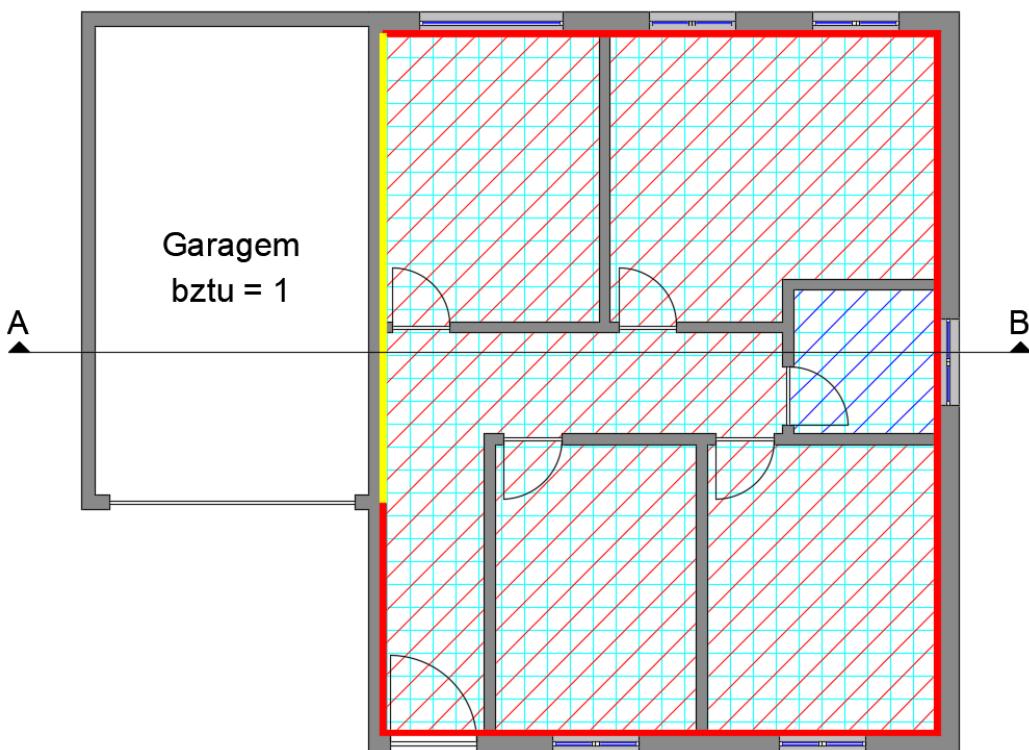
Exemplo de marcação da envolvente (planta esquemática)
